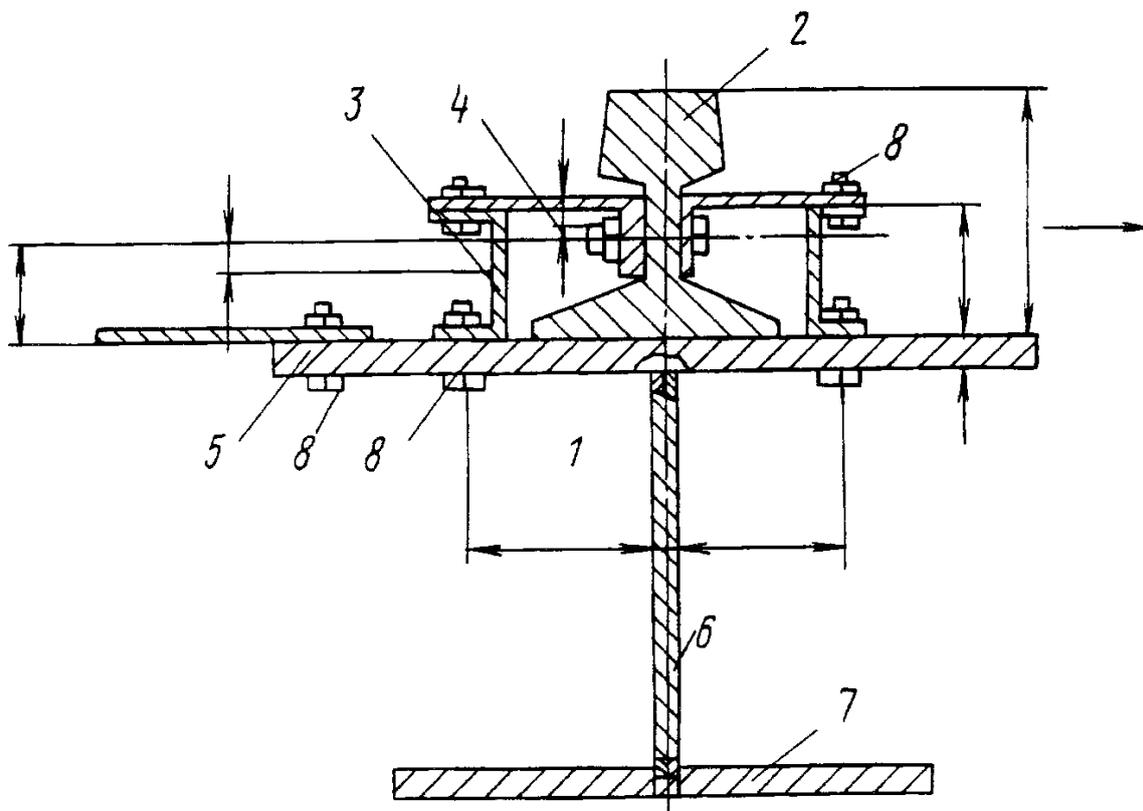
Поперечное сечение усиленной подкрановой конструкции
